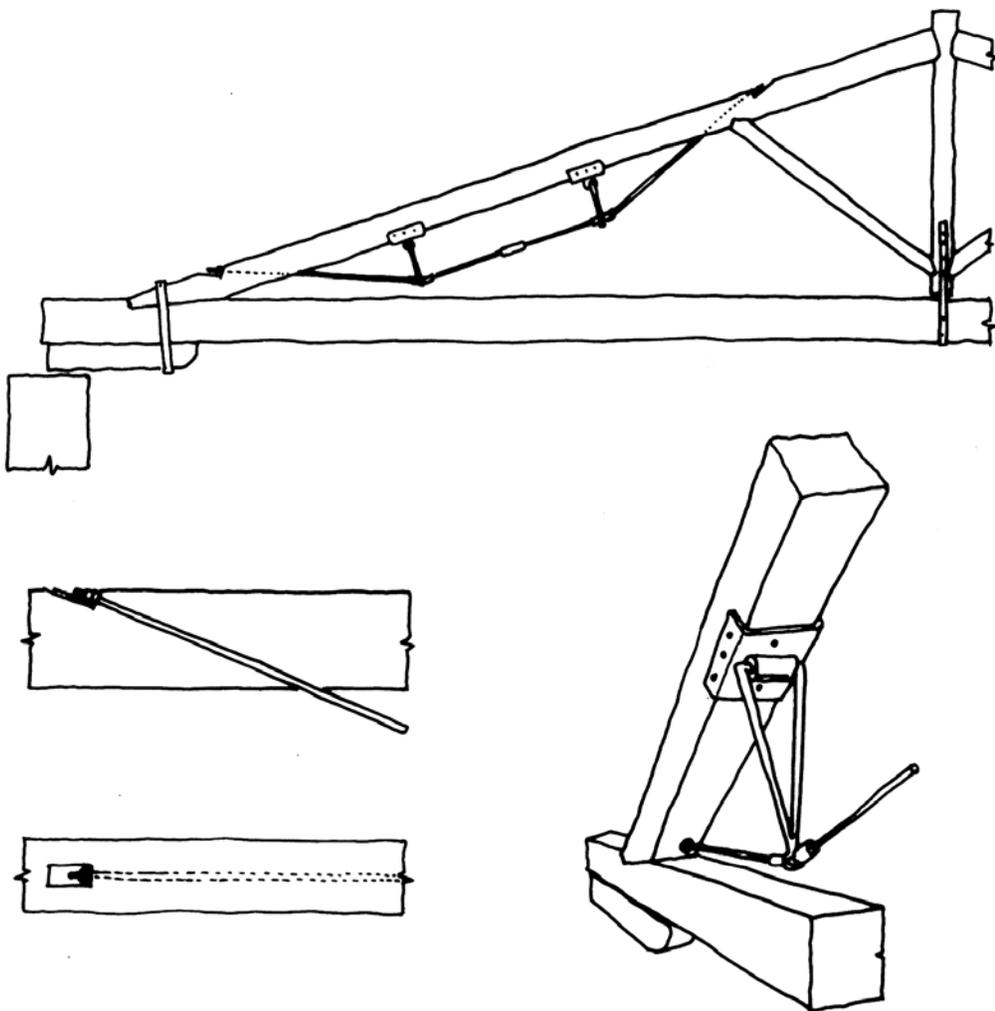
Refuerzo de un par mediante atirantado inferior.
